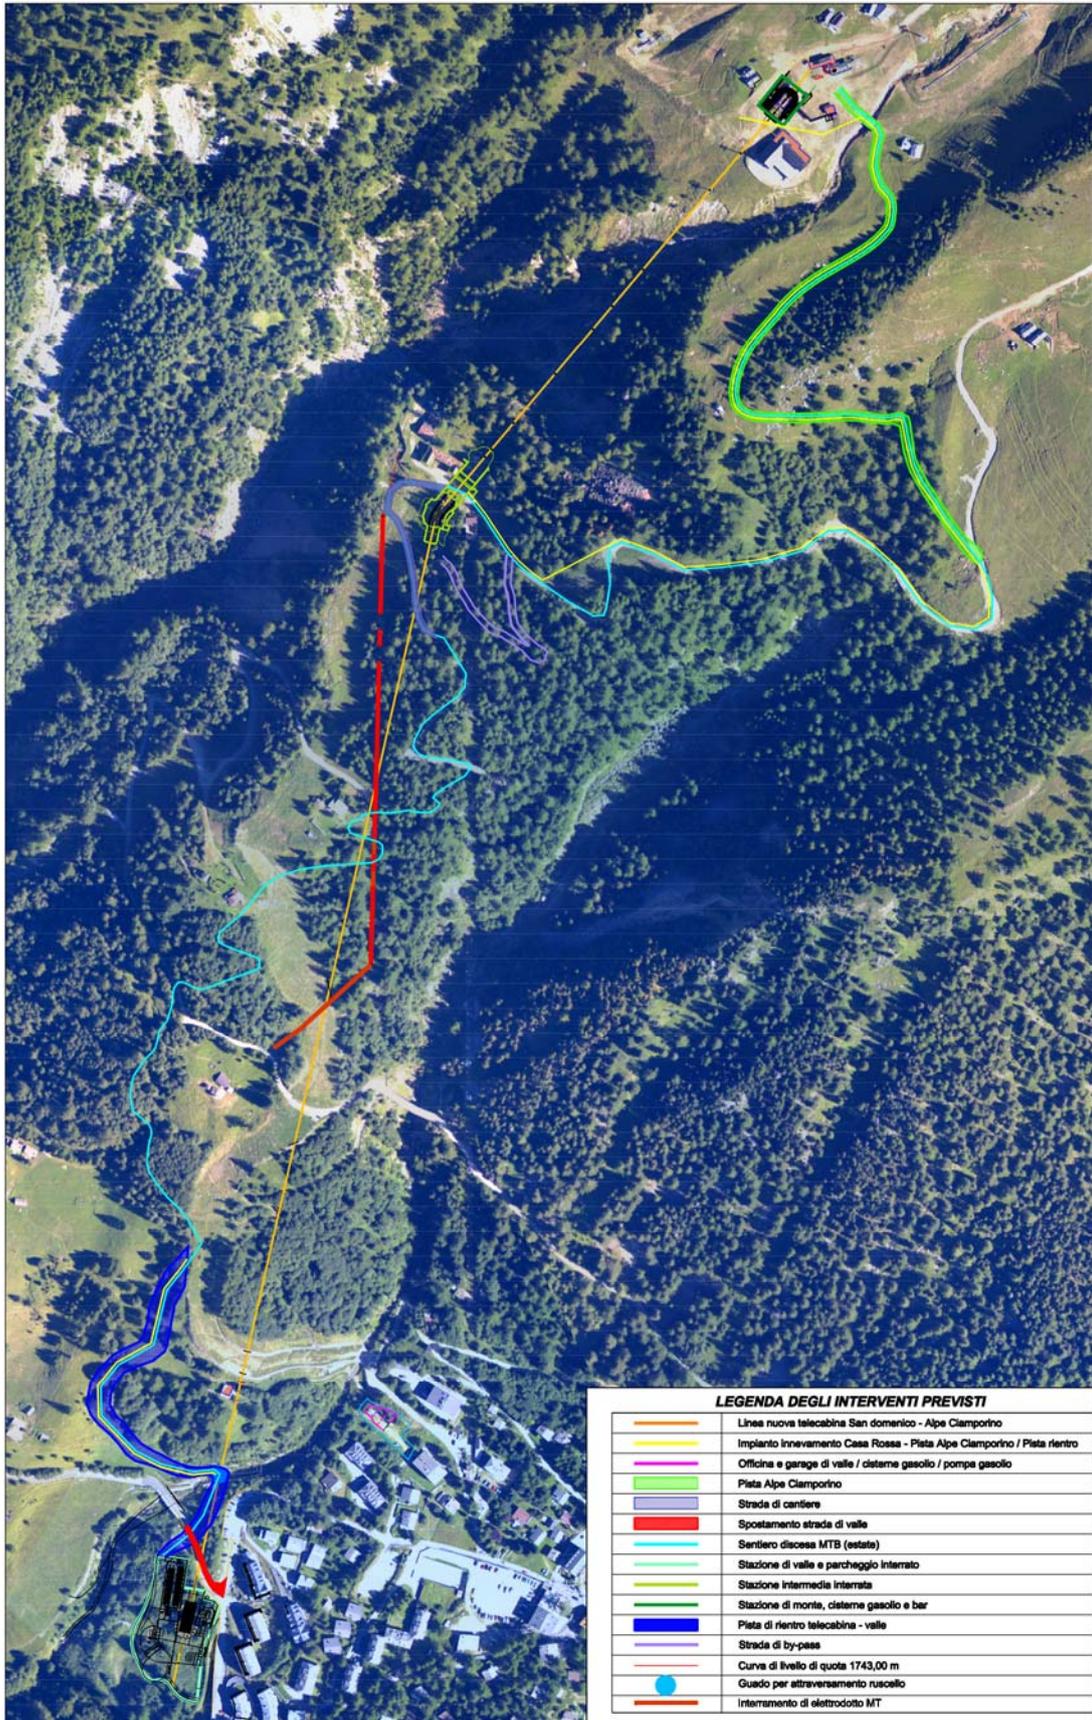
Planimetria di sintesi delle opere in progetto
